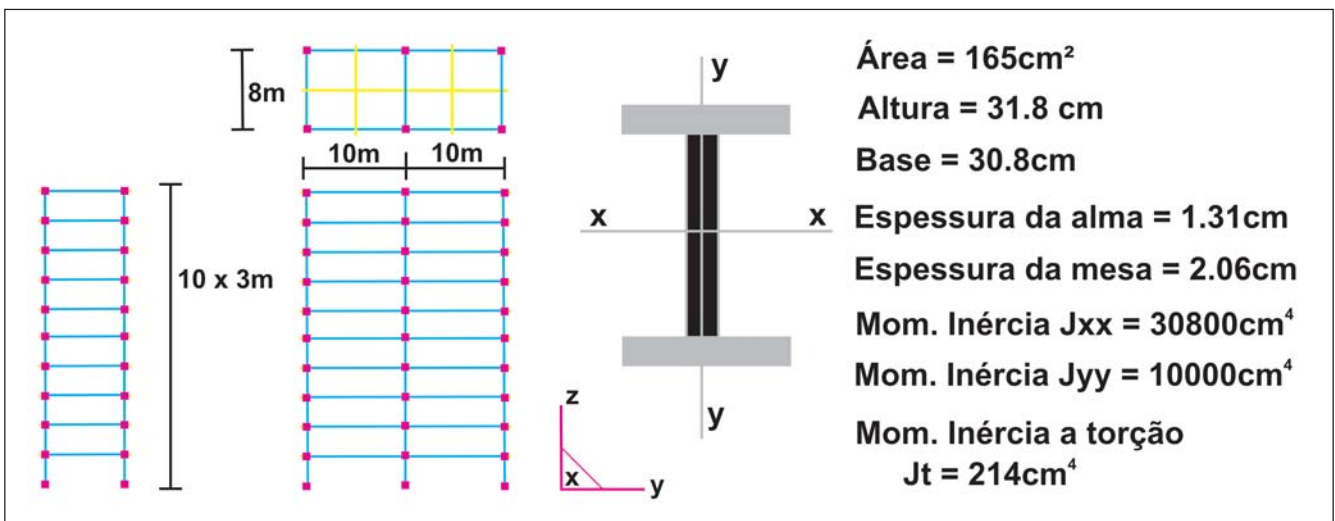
Planta baixa, cortes e propriedades geométricas.
